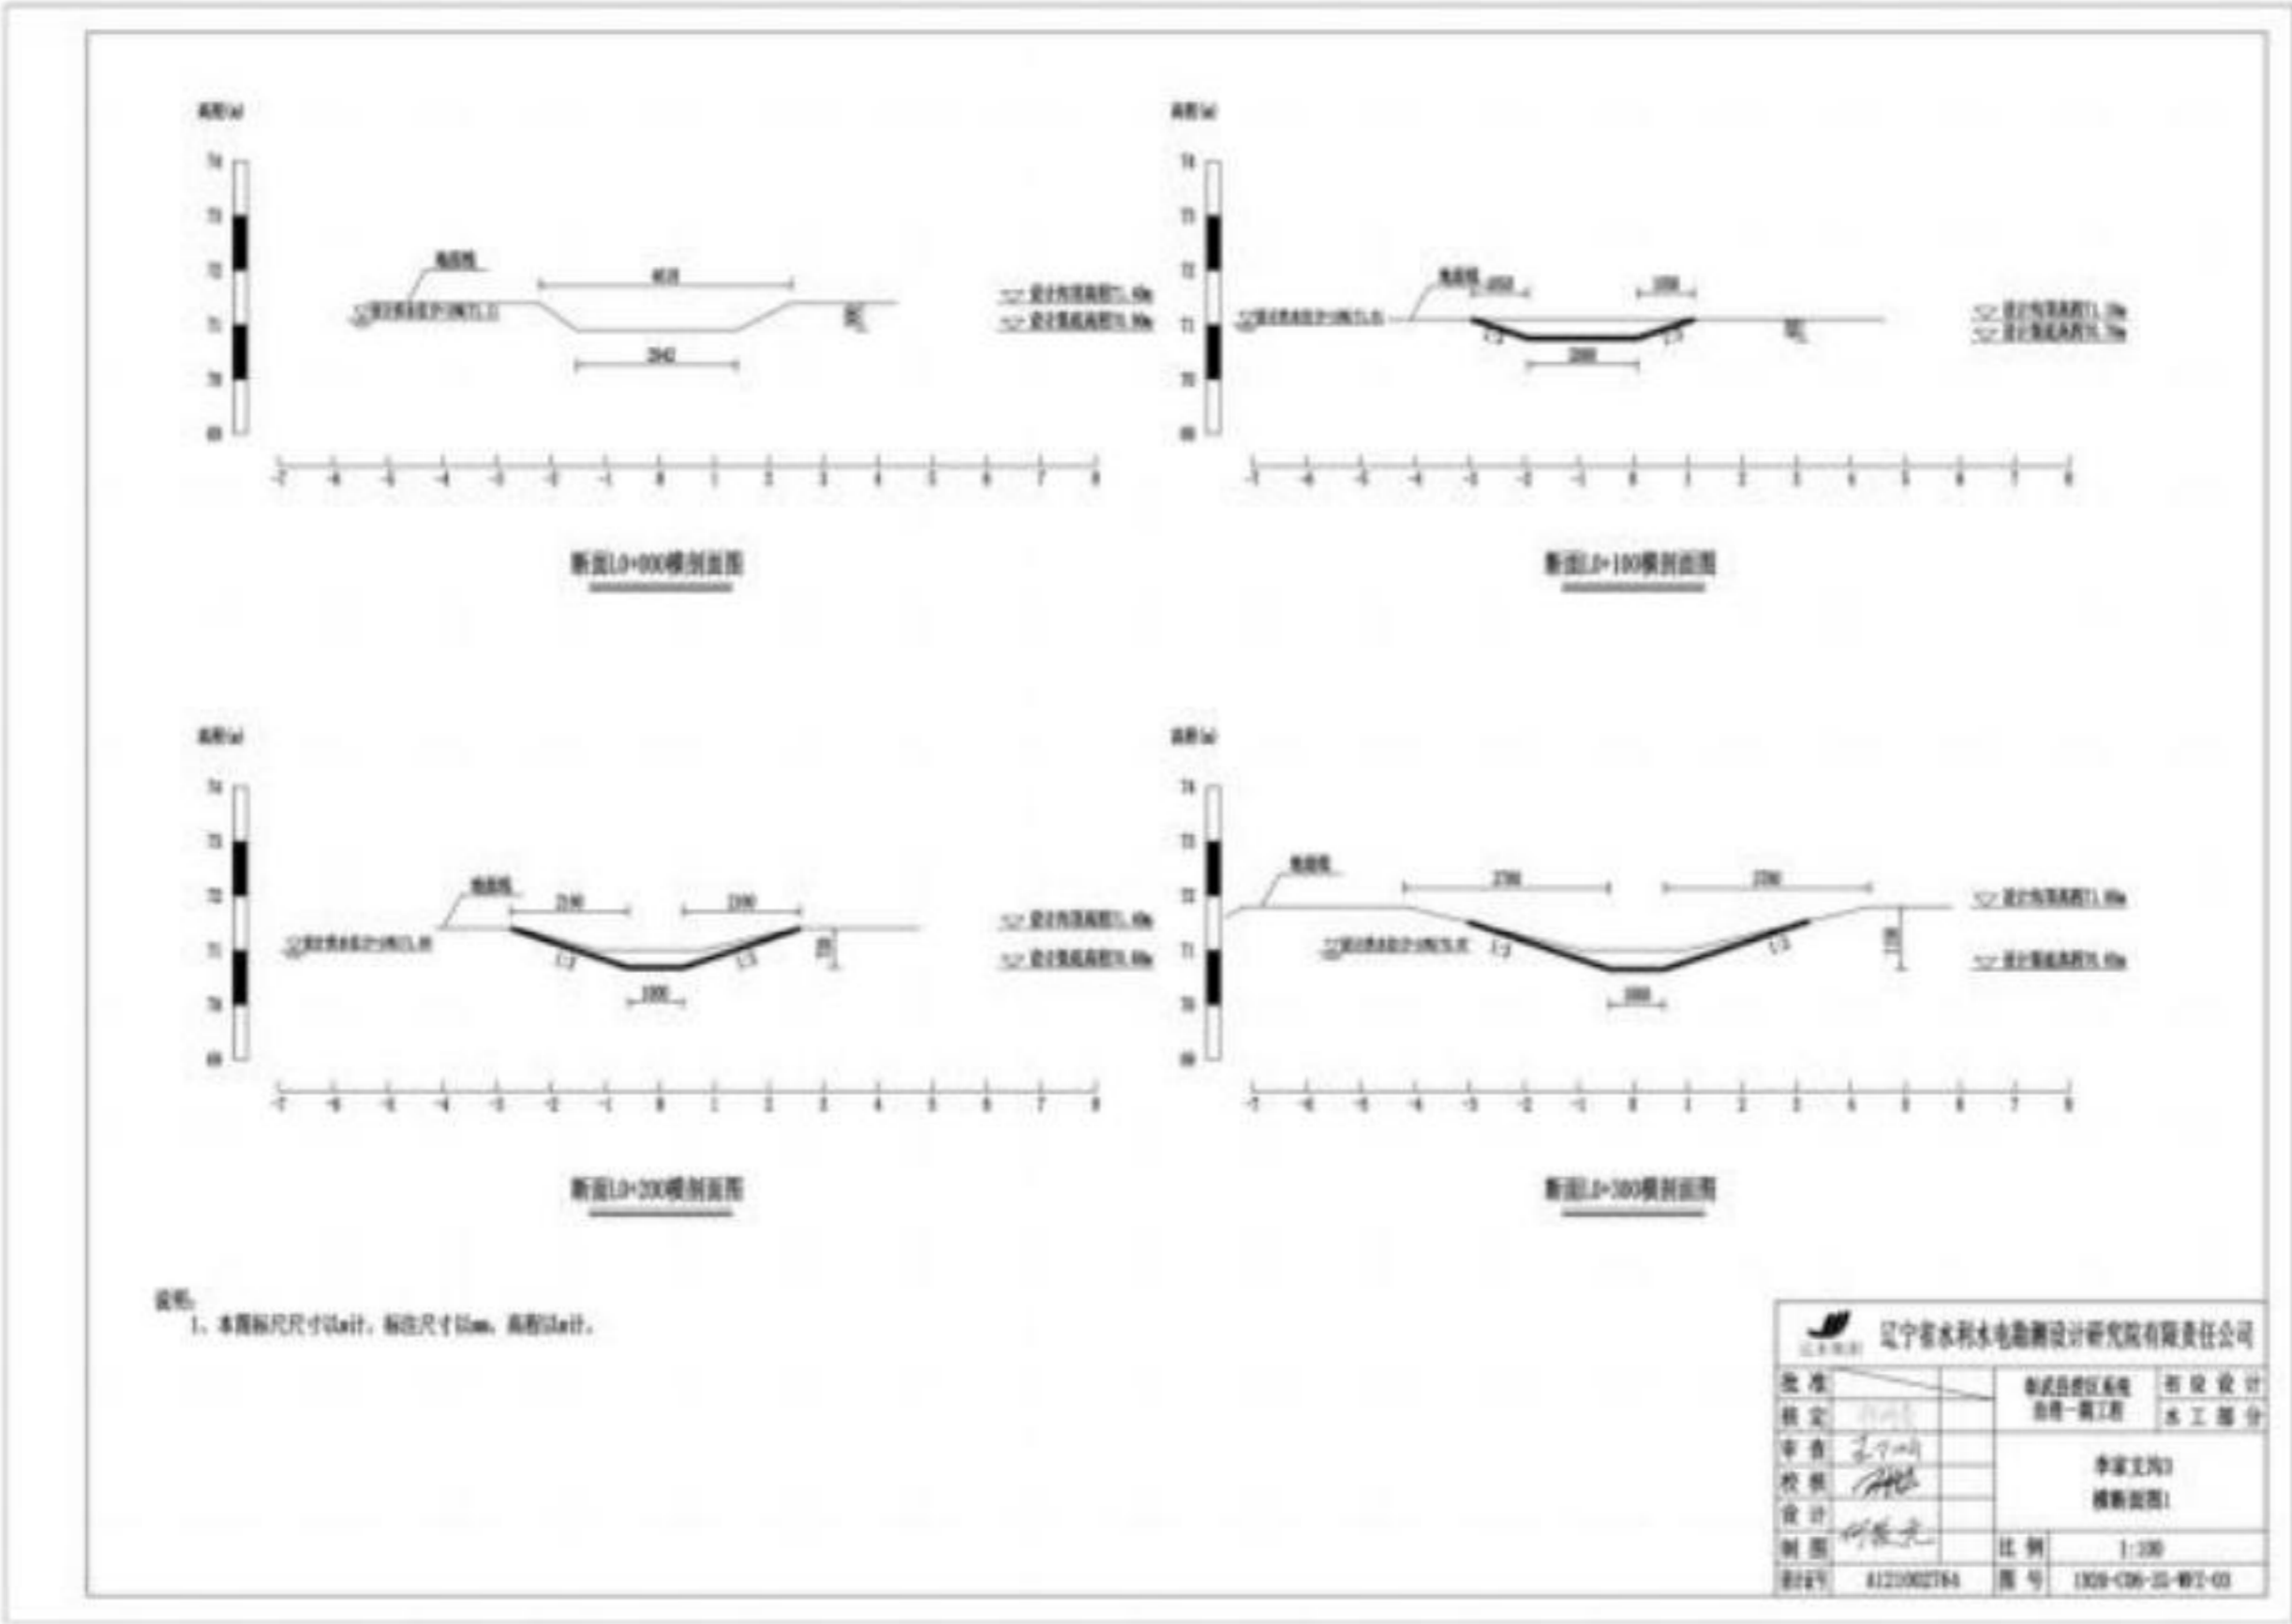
(1) 五峰镇李家支沟 3 剖面图
